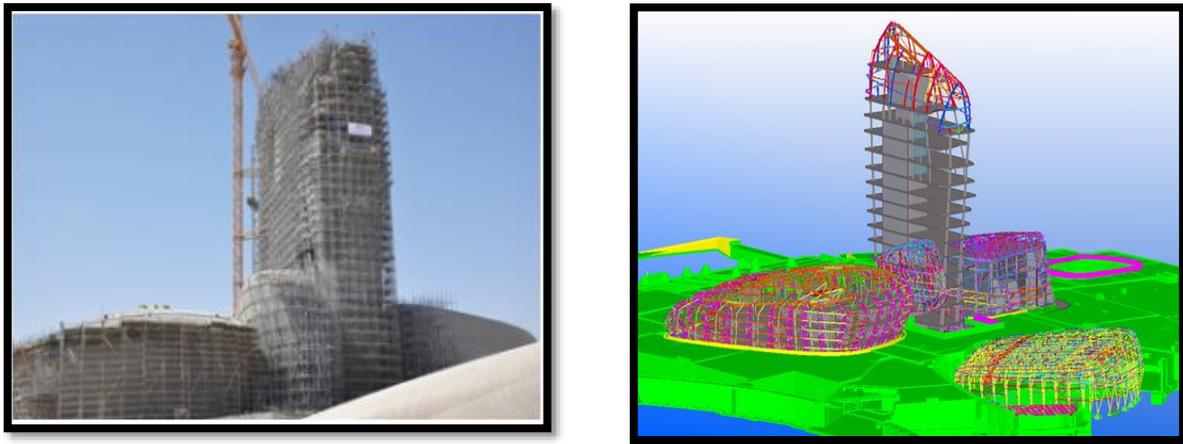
La combinaison entre structure en béton et structure tridimensionnelles en couvertures
